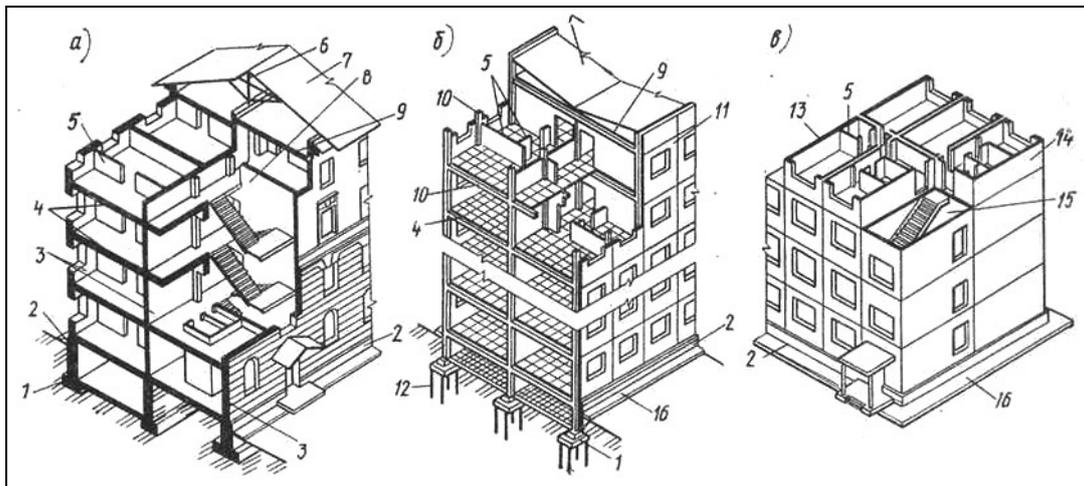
Основные элементы гражданских зданий [5]; а – гражданское здание с кирпичными стенами и скатной крышей; б – каркасно-панельное гражданское здание; в – объемно-блочное гражданское здание; 1 – фундамент; 2 – цоколь; 3 – несущие продольные стены; 4 – междуэтажные перекрытия; 5 – перегородки; 6 – стропильные конструкции крыши; 7 – кровля; 8 – лестничная клетка; 9 – чердачное перекрытие; 10 – ригели (балки) и колонны каркаса; 11 – навесные стеновые панели; 12 – сваи фундамента; 13–15 – объемные блоки комнаты (13), санузлов и кухни (14), лестничной клетки (15)
